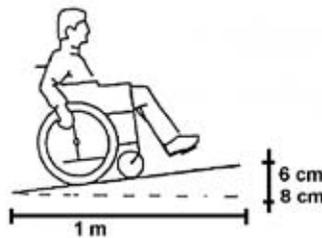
Cálculo da inclinação de rampa: para 6% por cada metro linear sobe-se 6 cm; para 8% sobe-se por cada metro linear 8 cm. Modificado de ⁽¹⁴⁵⁾.
